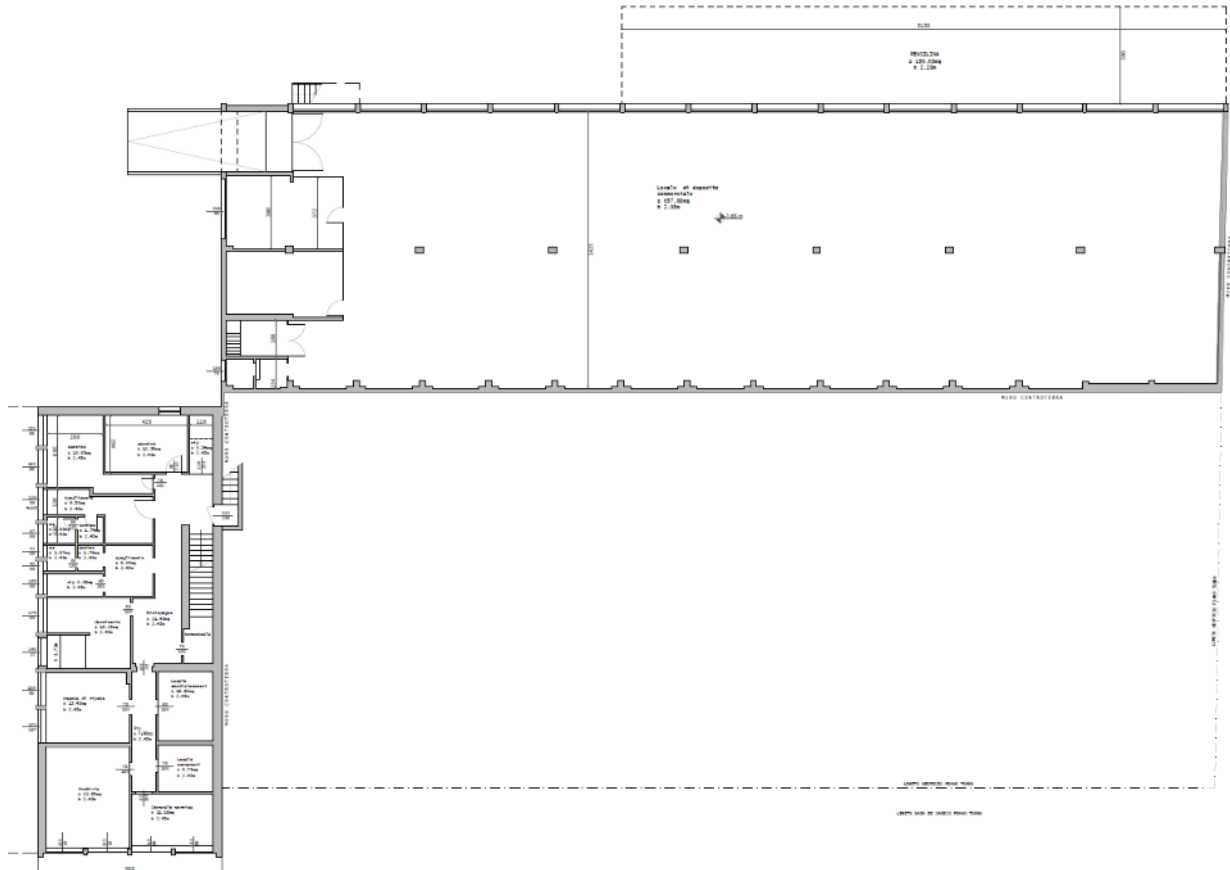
Stralcio elaborato T2 SDF-Pianta piano seminterrato stato di fatto
